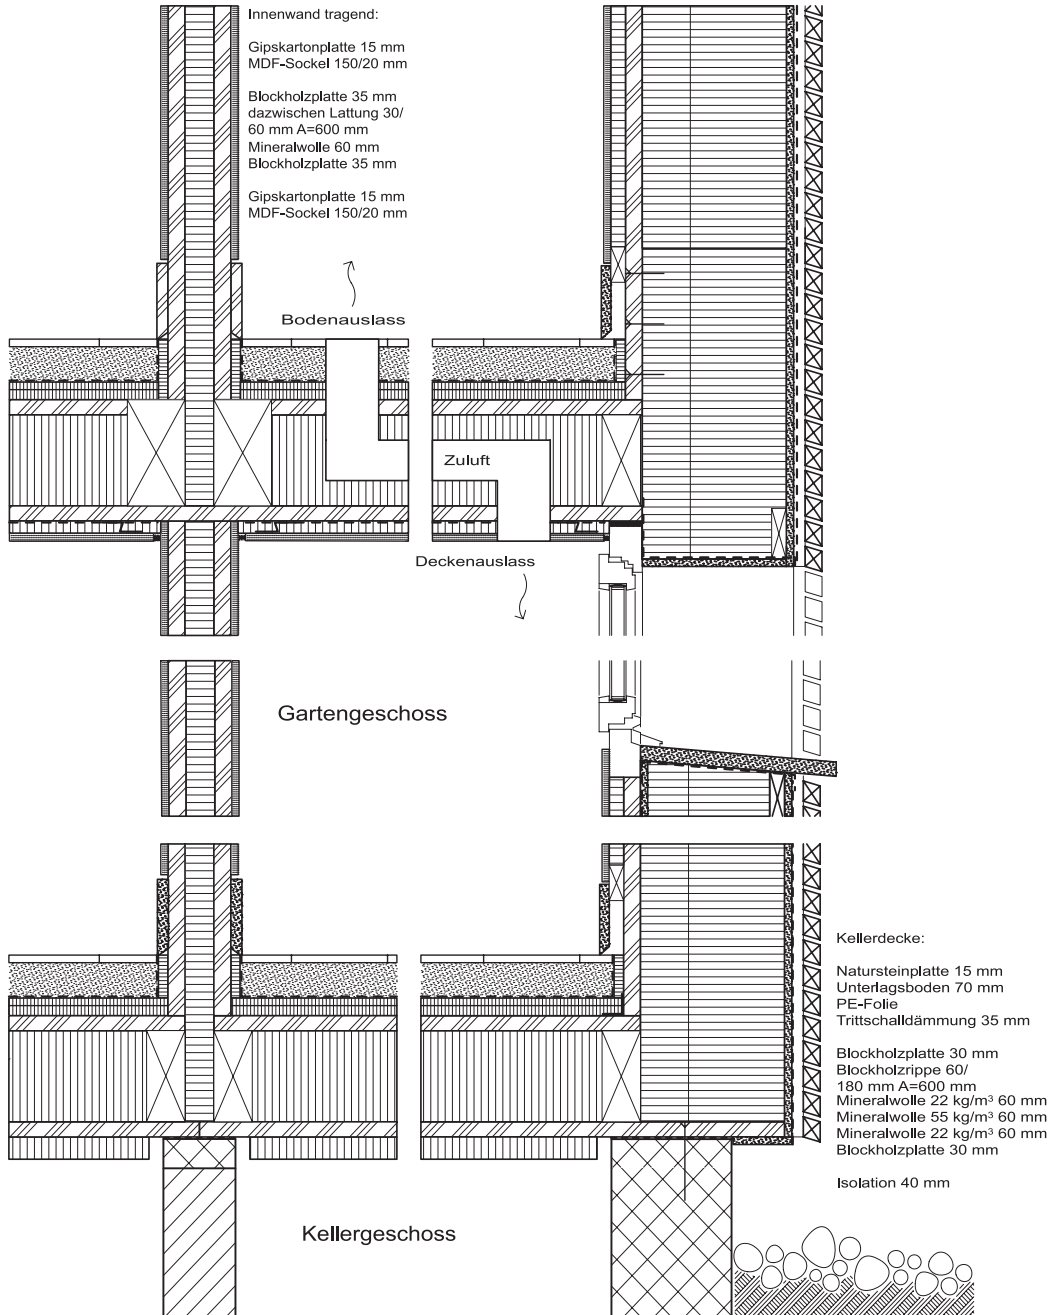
Schnitt durch Detail Kellerdecke und Aussenwand.
